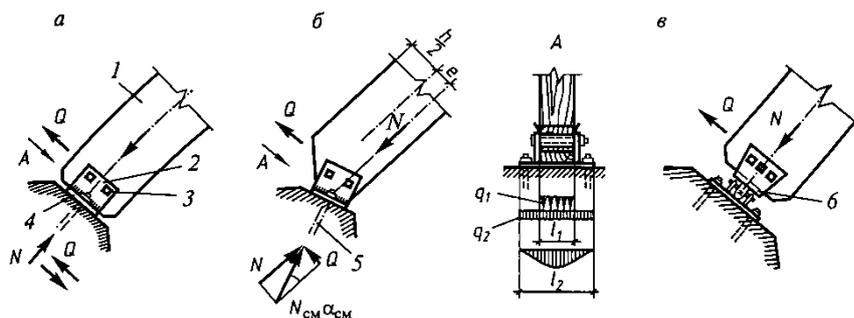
Опорные узлы клеедеревянных арок без затяжек: а — сегментной; б — треугольной; в — большепролетной; 1 — арка; 2 — стальной башмак; 3 — болт; 4 — сварной шов; 5 — анкер; 6 — шарнир
